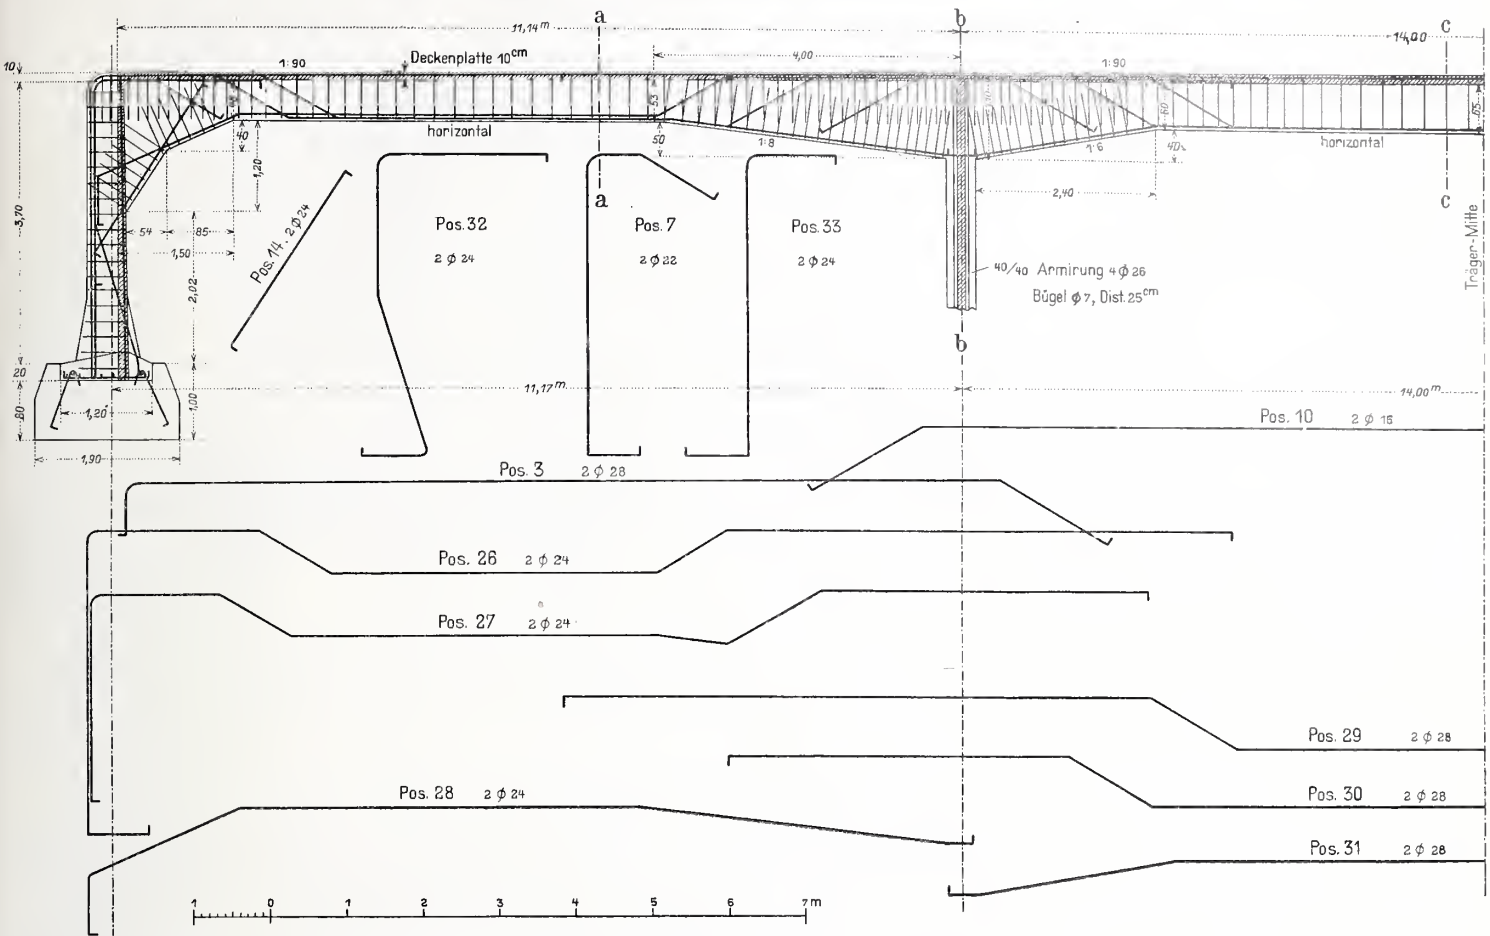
Armierungsplan des Decken-Trägerrahmens und Schnitt durch Erdstützmauer und Deckenplatte. — 1:100.
